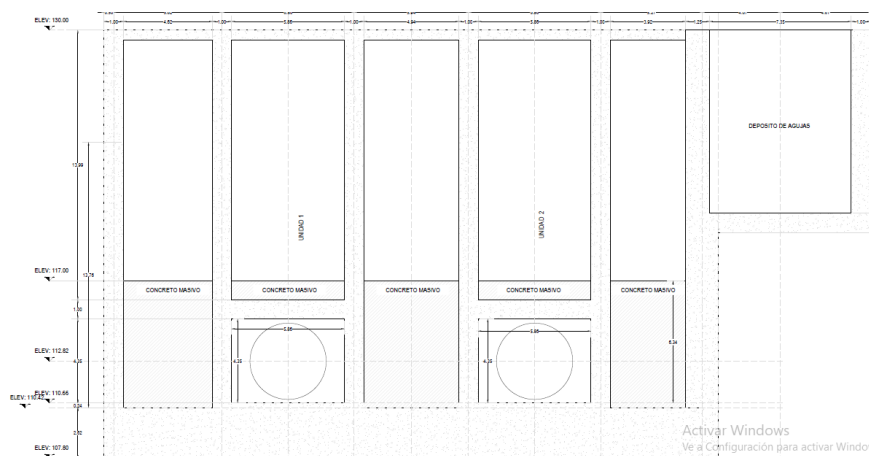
Sección de planta de excavación de casa de máquinas y canal de desfogue (Disciplina de Estructuras).
